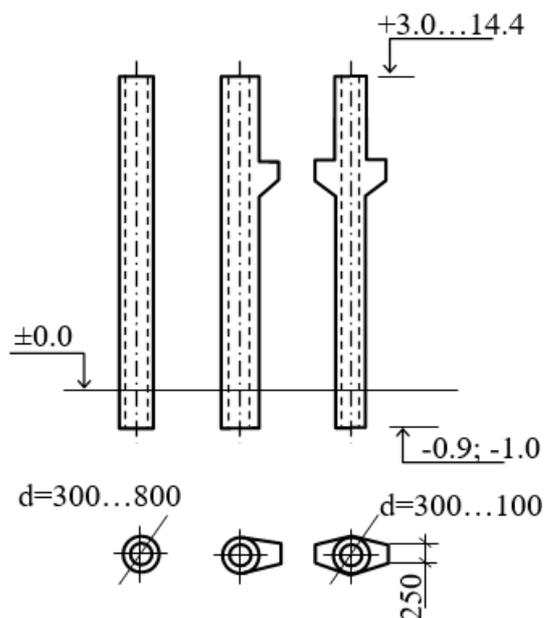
Сборные железобетонные колонны кольцевого сечения
